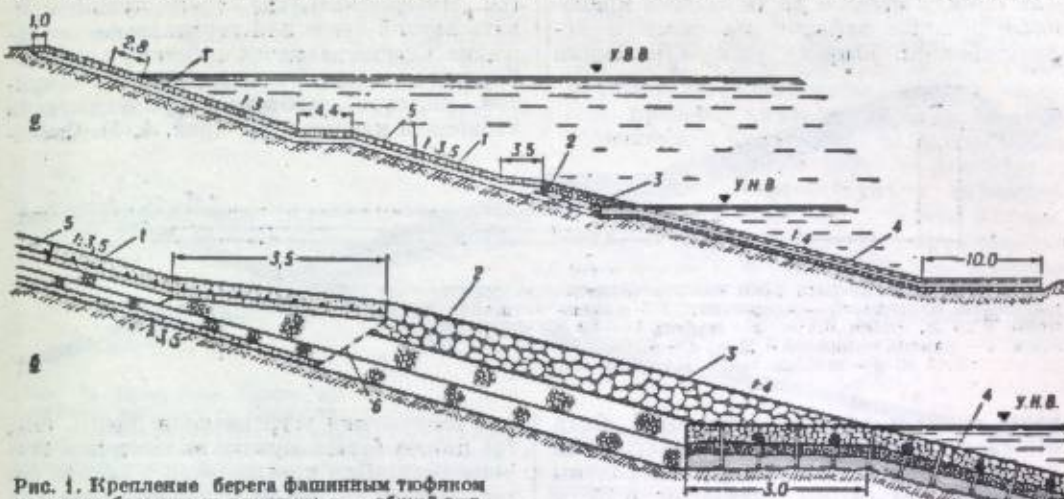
Крепление берега фашинным тюфяком и железобетонными плитами: а — общий вид, б — детали; 1 — бетонные плиты толщ. 0,3 м на 3-слойном обратном фильтре толщ. 0,45 м; 2 — укладка камня слоем 0,6 м (нижние слои); 3 — наброска камня слоем 0,6 м (верхние слои); 4 — фашинный тюфяк 0,4 м, пригруженный камнем слоем 0,2 м; 5 — просмоленная доска; 6 — граница отсыпки под воду.
